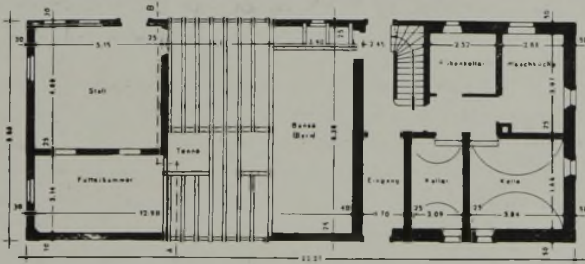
Kellergeschoß unter der Wohnung (zu Abb. 11) mit Stall, Futterkammer, Tenne und Barn. Das Tennegebälk ist mit eingezeichnet.
